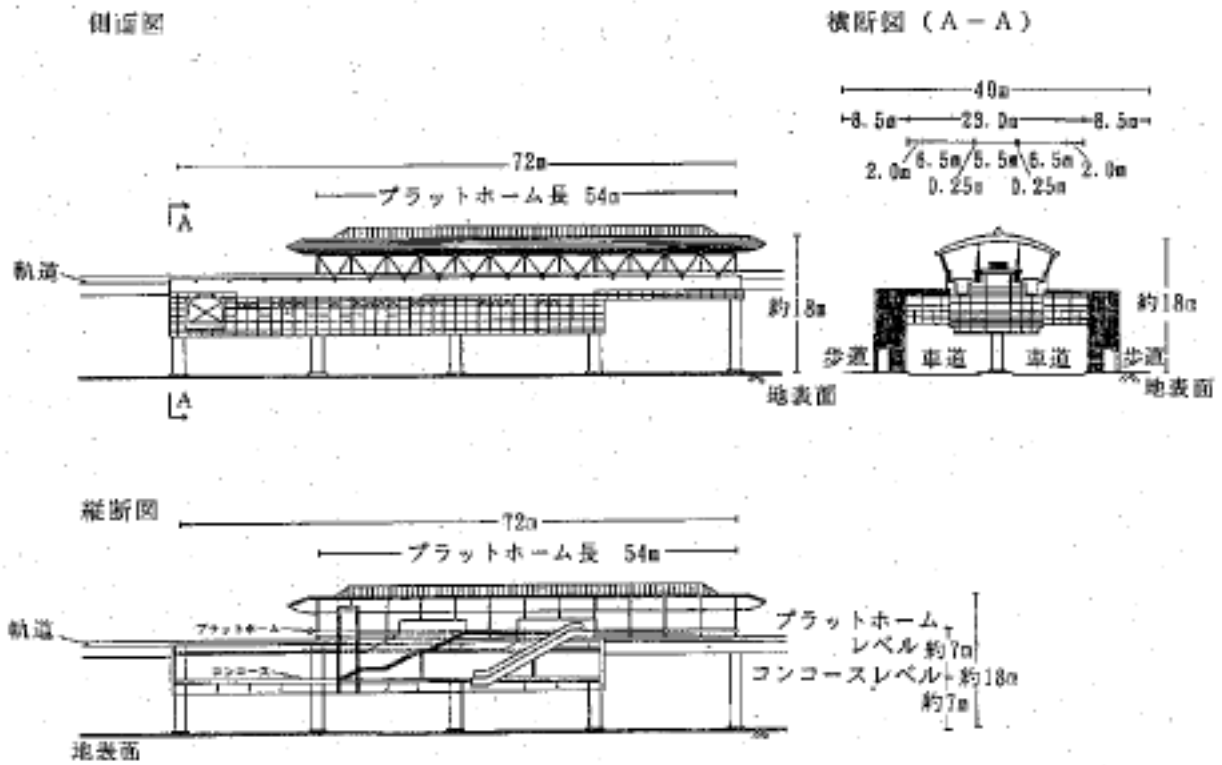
(1) 駅舎部の立面図及び断面図 (標準駅)
